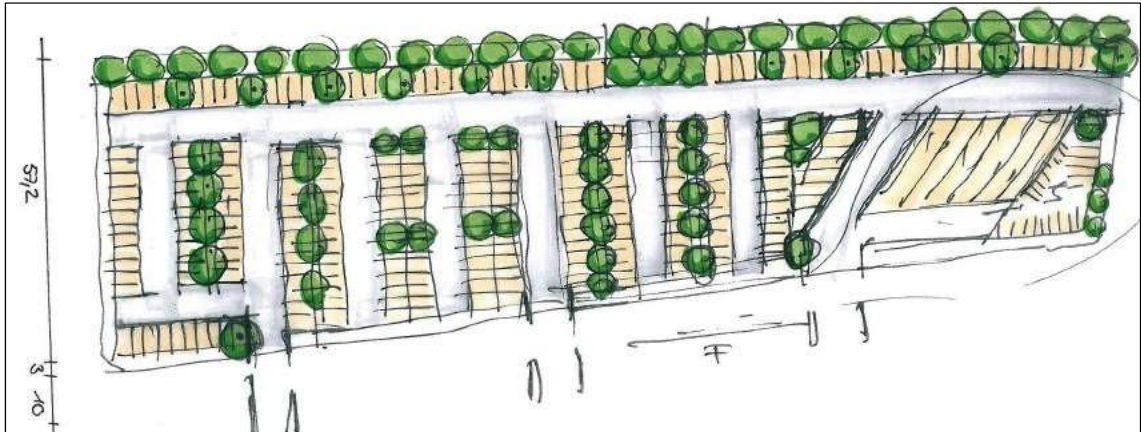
Abbildung N: mögliche Gestaltungsvariante für den öffentlichen Parkplatz [16]
